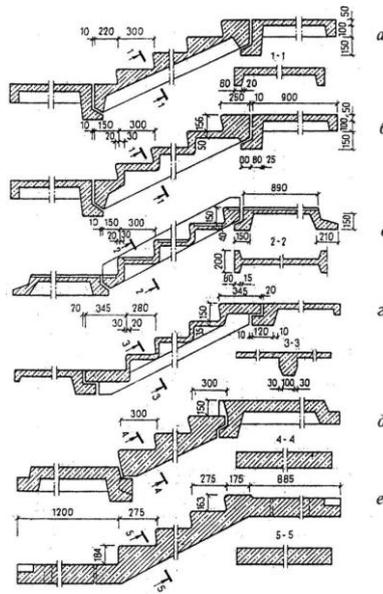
Конструктивные решения железобетонных сборных лестниц из крупных элементов:
